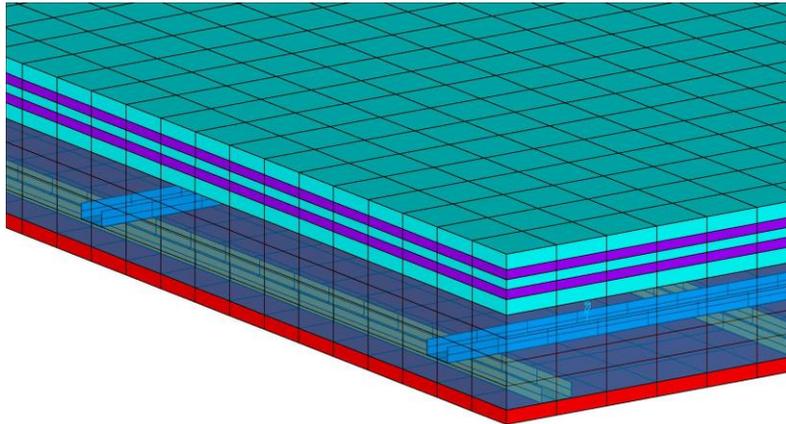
FE-Model einer Brettsperrholzdecke mit Unterdecke, die Luft im Hohlraum ist mit Fluidelementen modelliert
